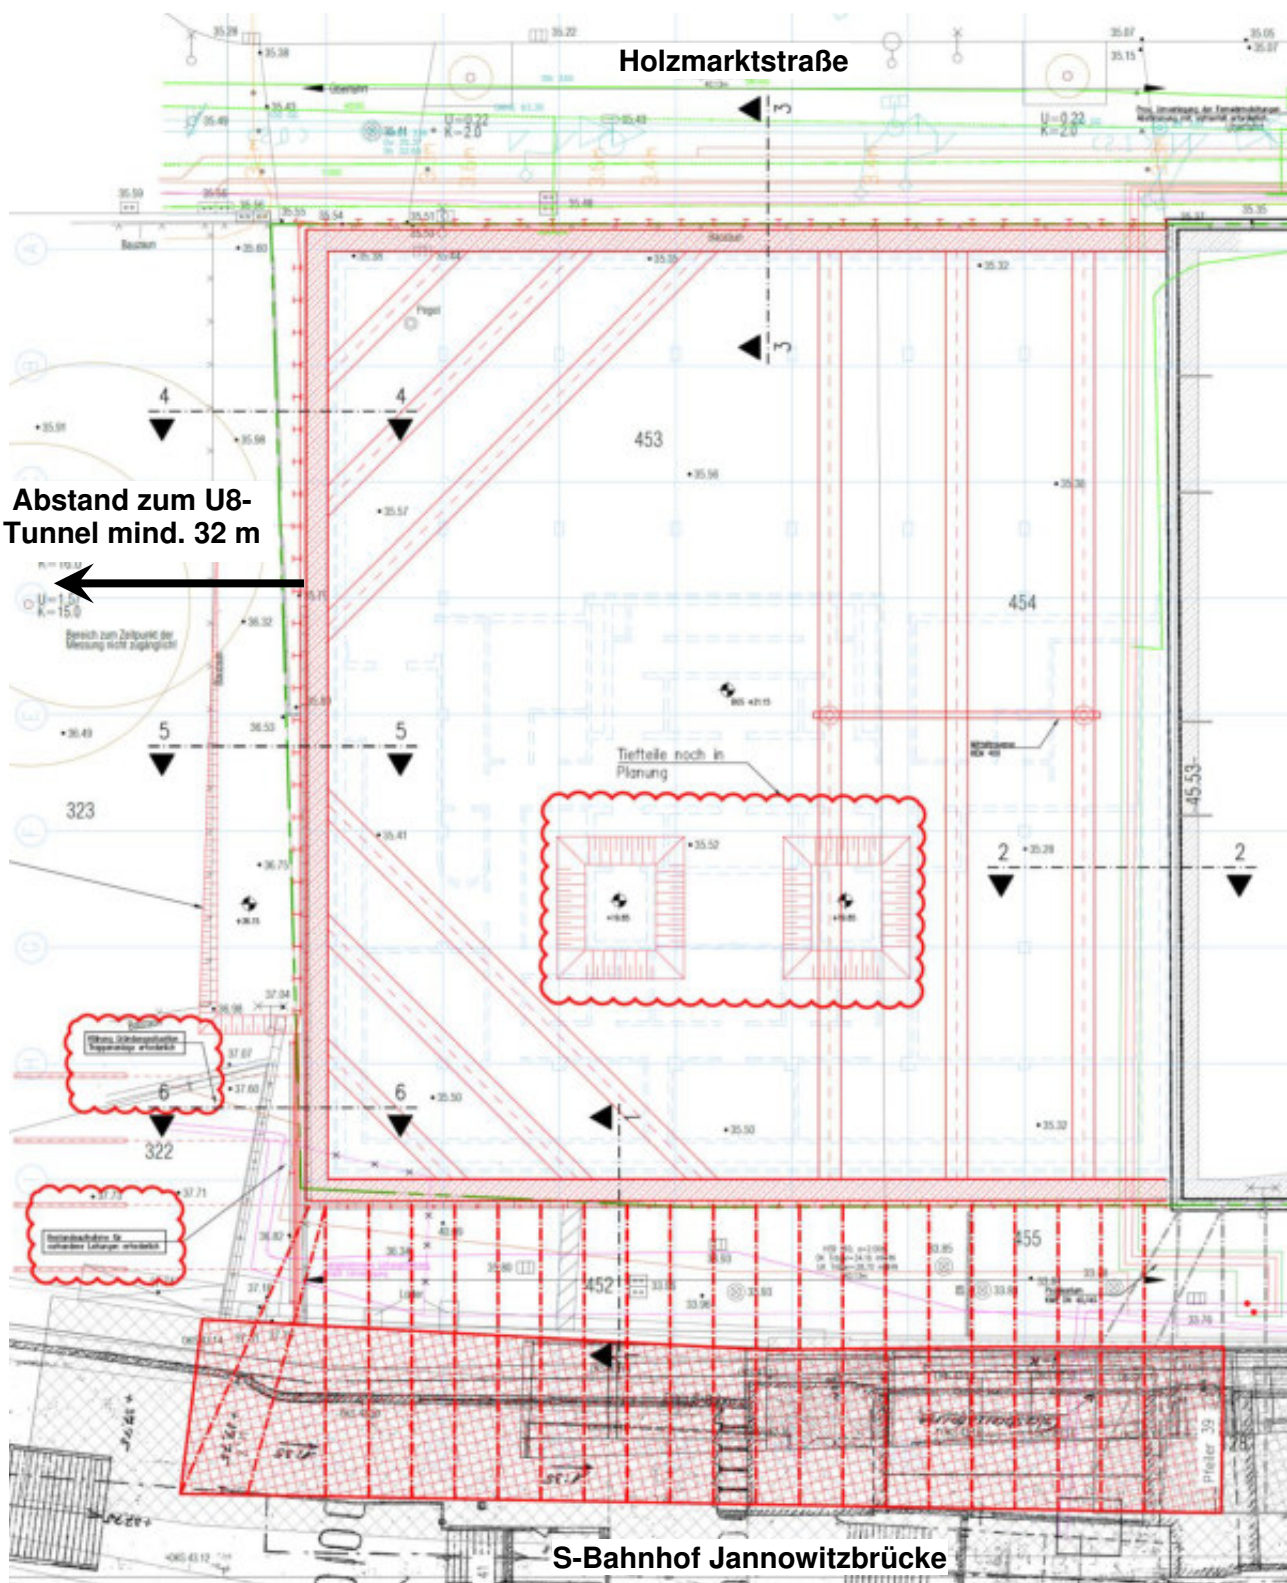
Grundriss Baugrube JAH0 2 aus [S 3]
